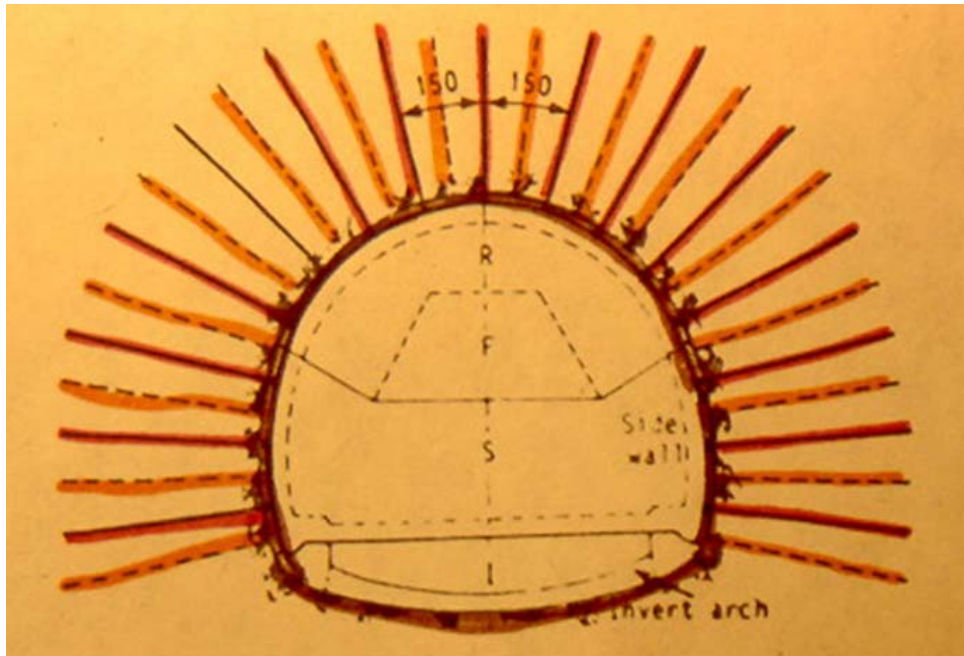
Estabilizado de las paredes del túnel por medio de concreto lanzado y anclas.
